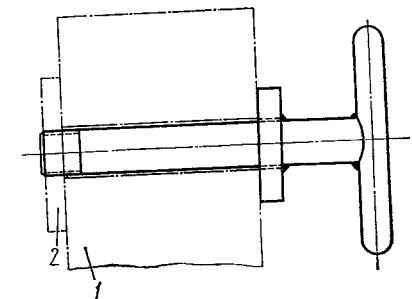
Фиксатор для крепления закладных деталей с нарезным отверстием:
